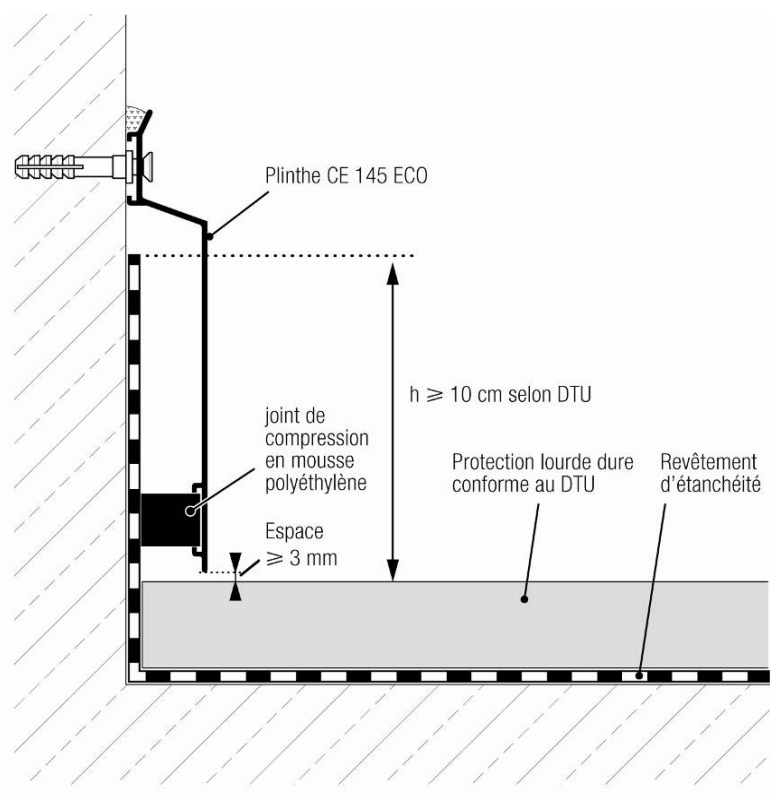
Toiture-terrasse accessible aux véhicules légers
